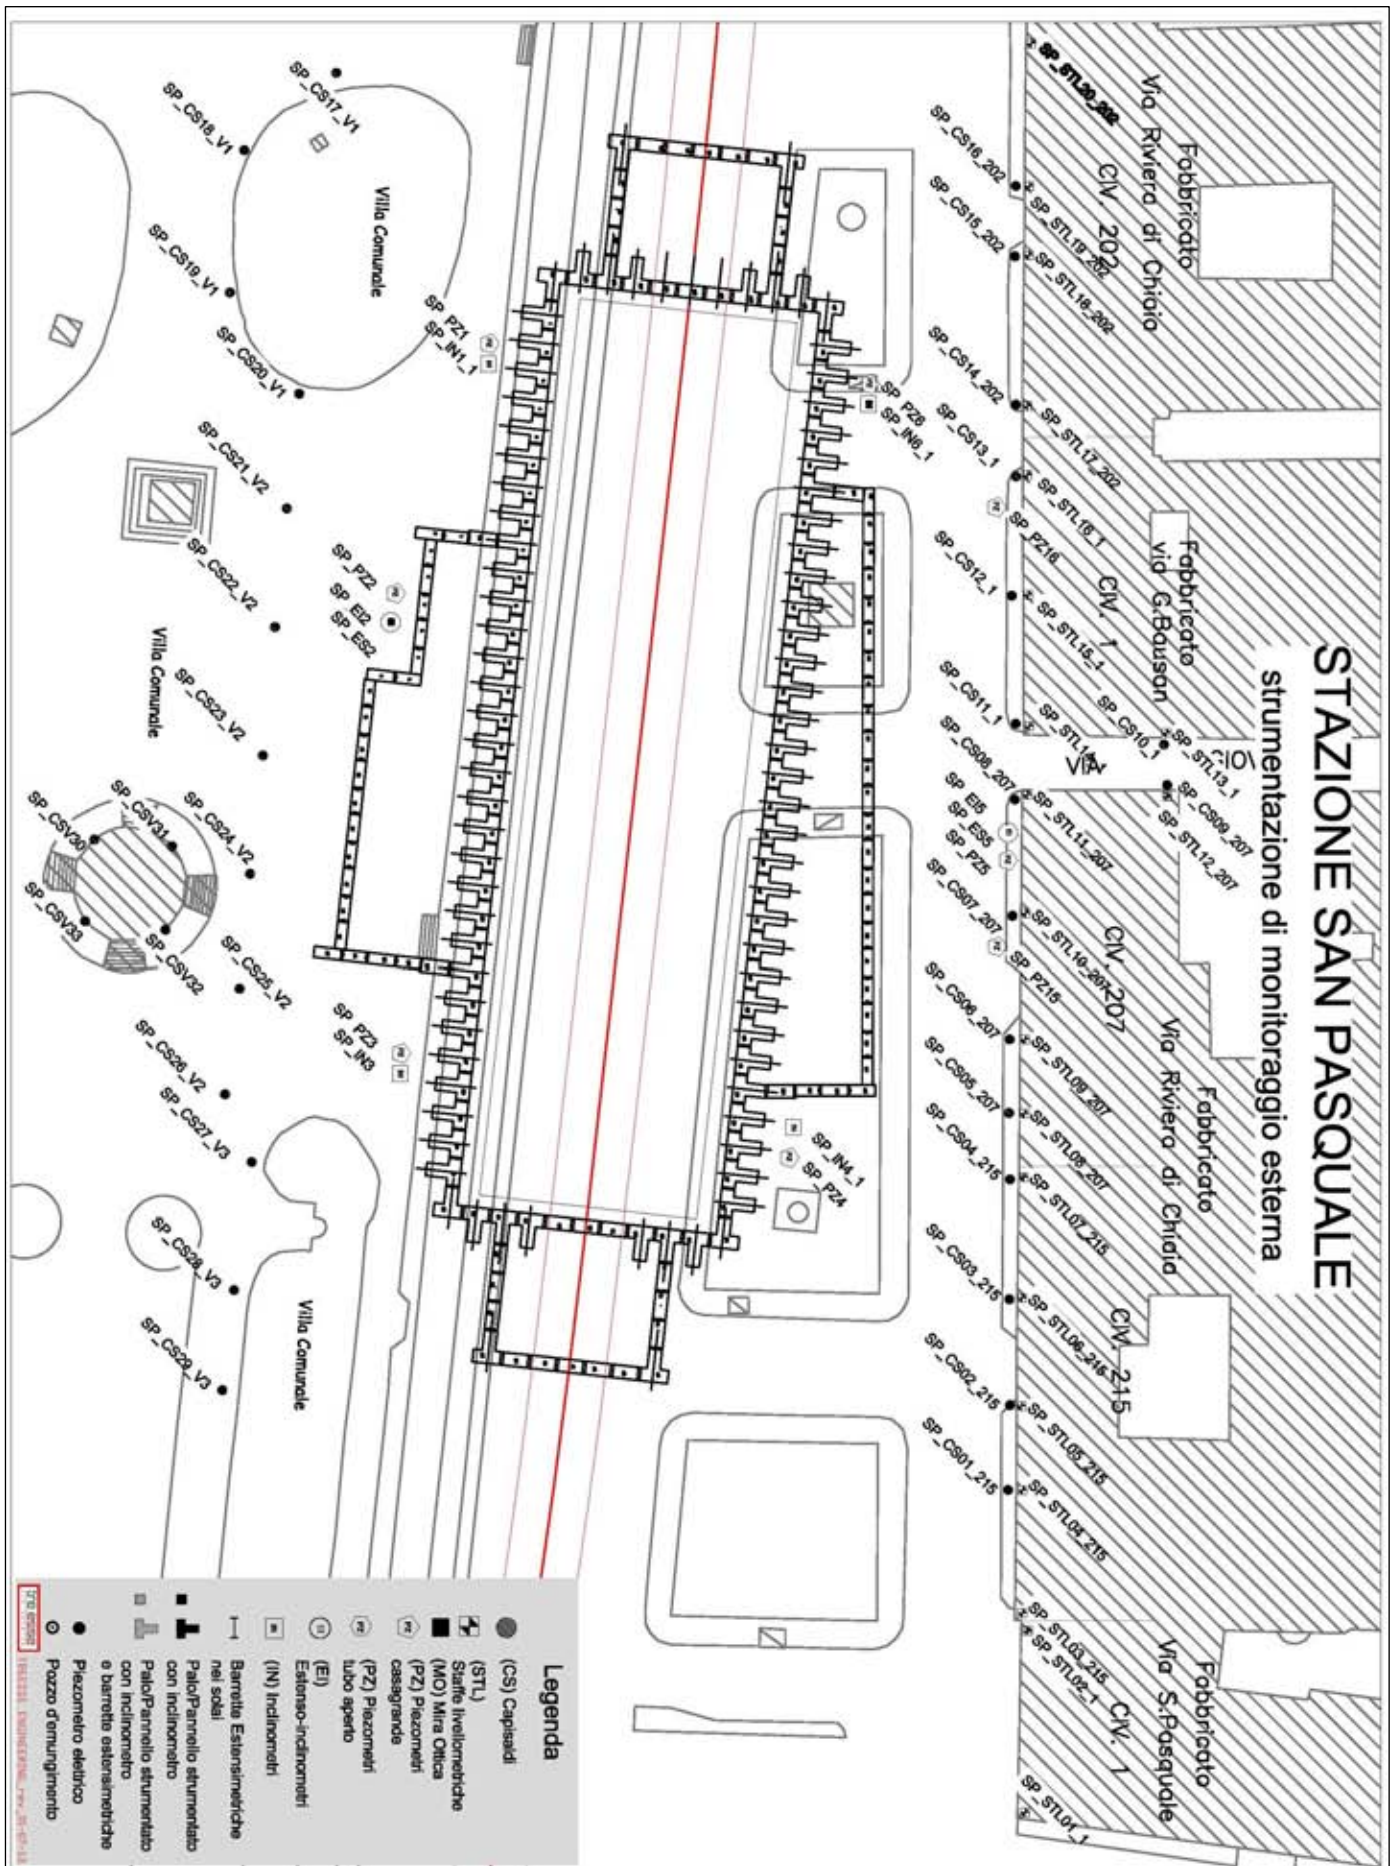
Planimetria pozzo stazione, raffigurante la disposizione della strumentazione di monitoraggio topografico e geotecnico esterna.
